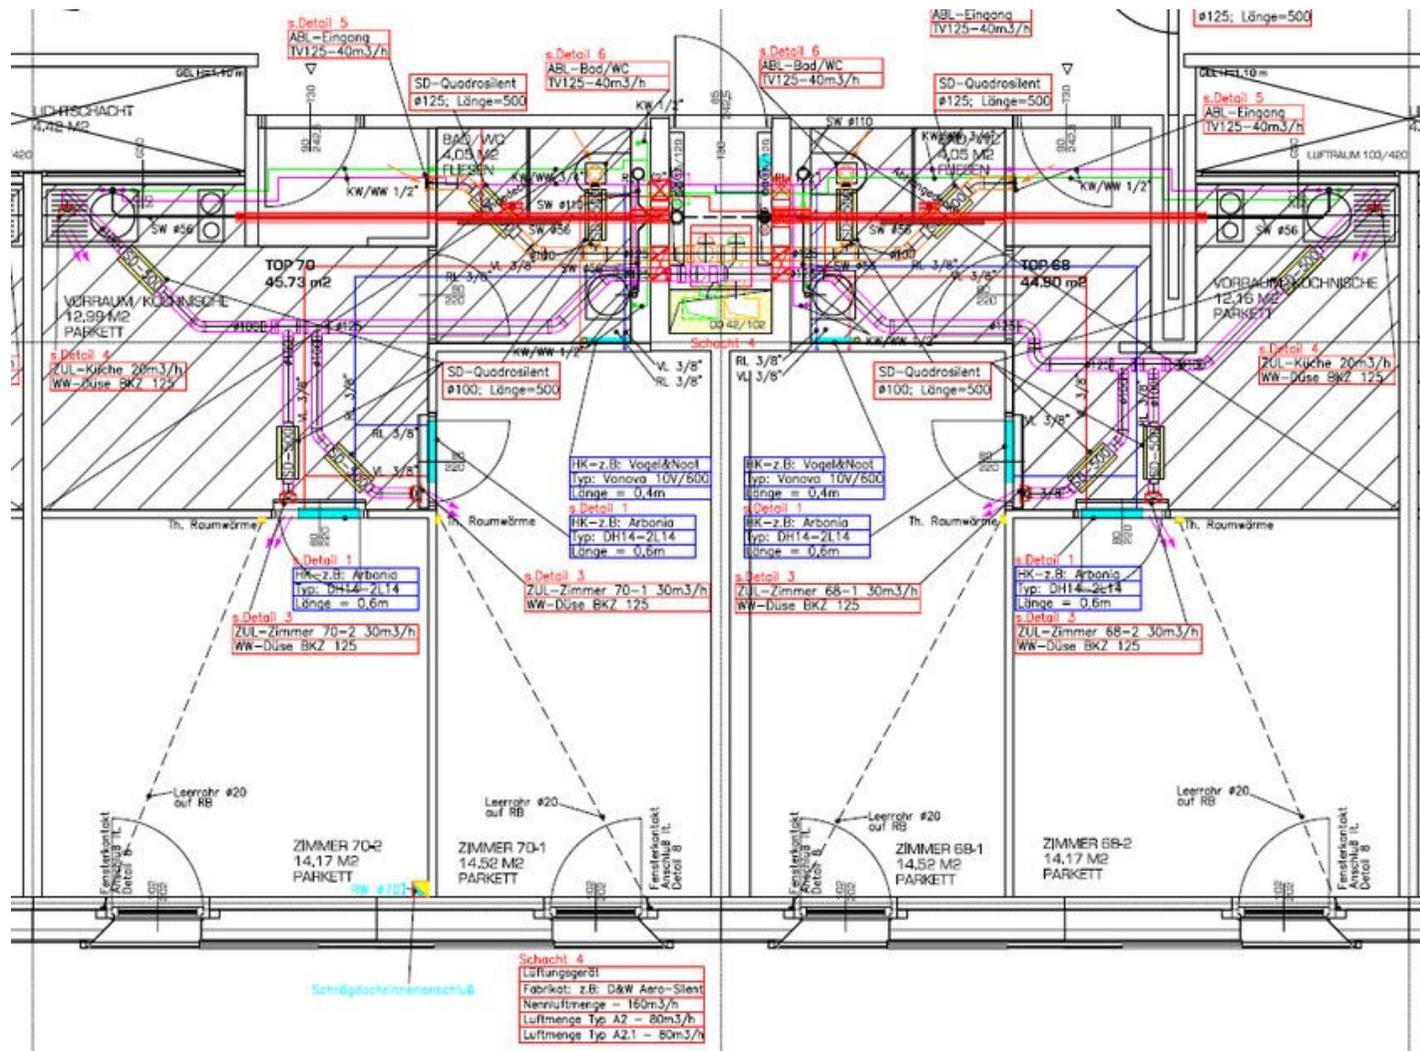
Ausschnitt aus dem Ausführungsplan HLS – 2./3./5. OG vom 15.10. 2003. Grundriss 3. OG. Top 68 und Top 70. Mit freundlicher Genehmigung vom Haustechnikplaner Team GMI und Architekturbüro P.ARC GmbH. Zwei Standard-2-Zimmer-Wohnungen werden von einem dezentralen Komfortlüftungsgerät versorgt.
